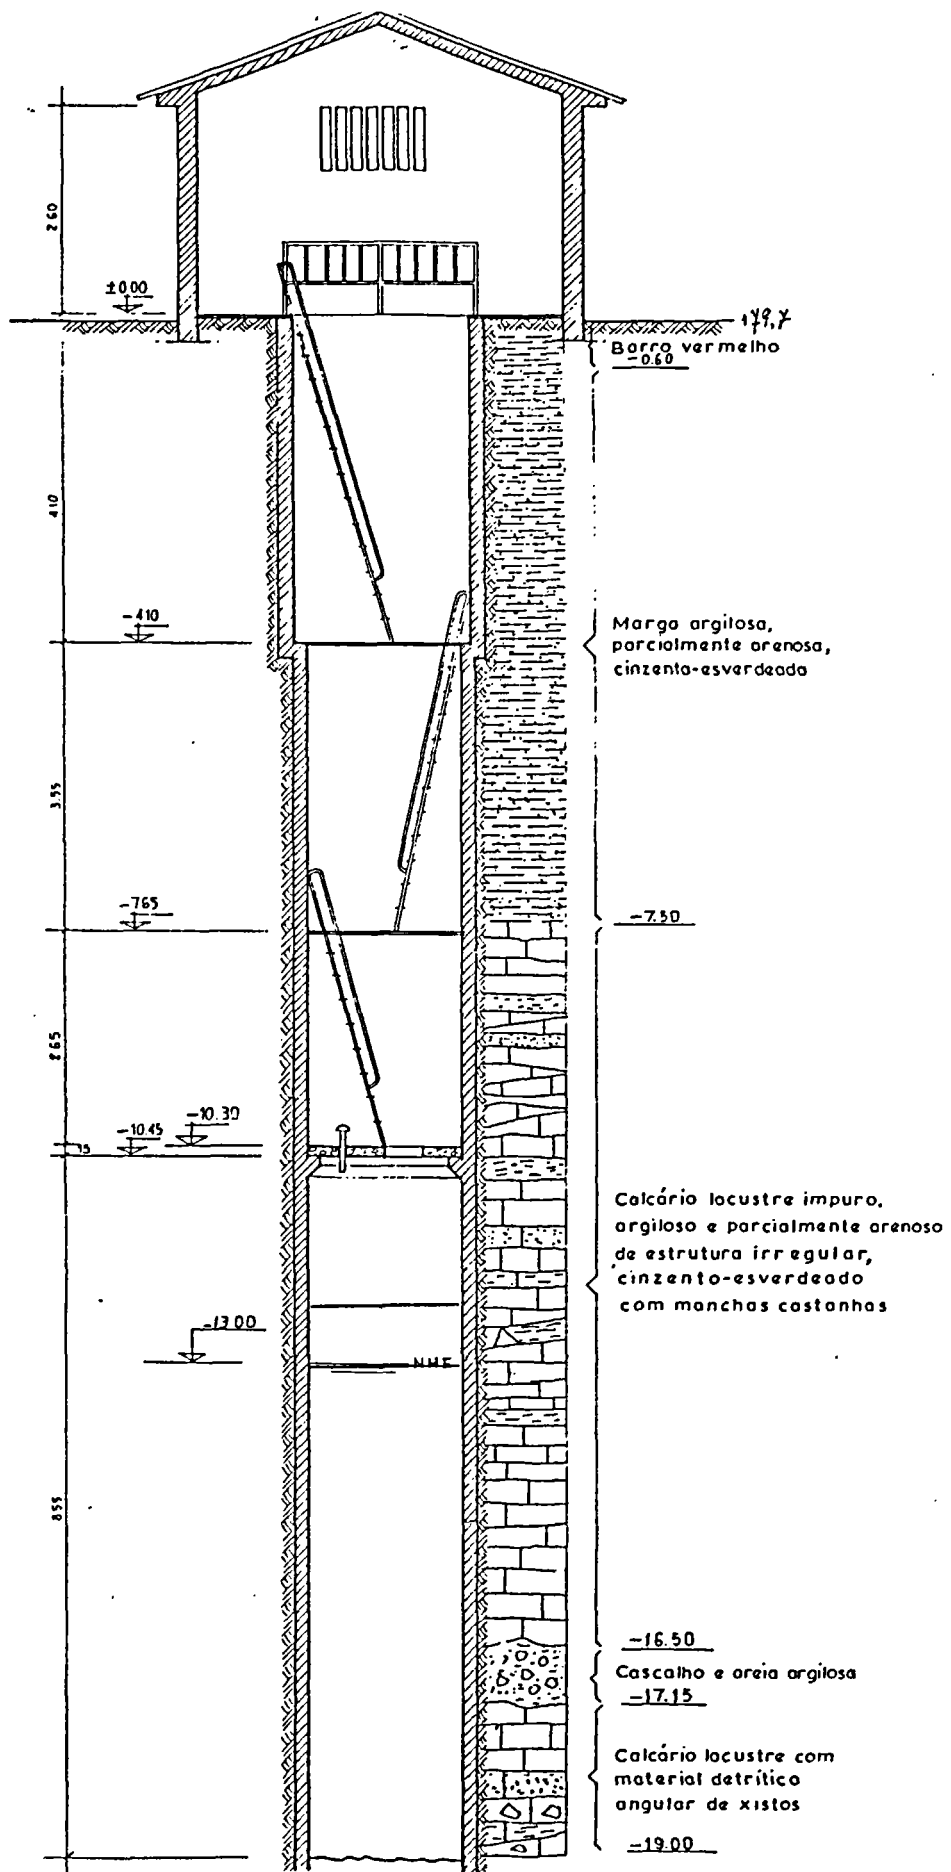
Coupe et équipement du puits n° 7 - Pisoës.
